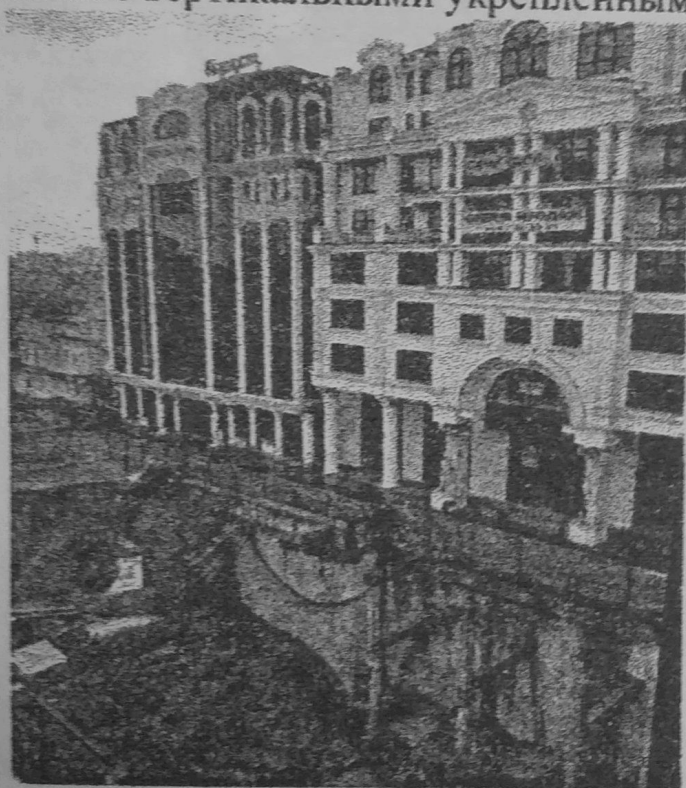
Обрушение стенок котлована на Греческой площади в Одессе
